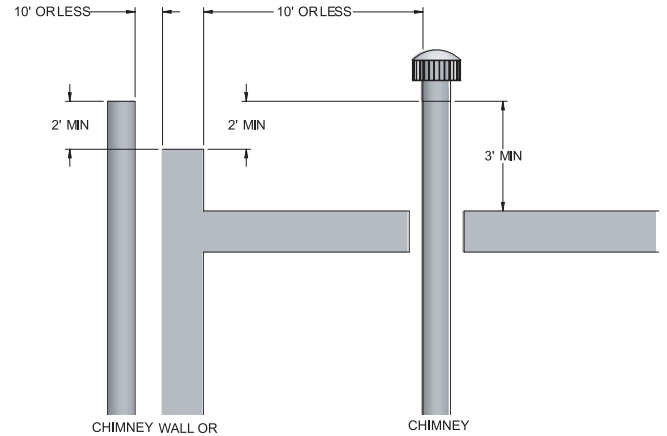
Terminaison de ventilation depuis un toit en terrasse - à 10 pieds au maximum du parapet
